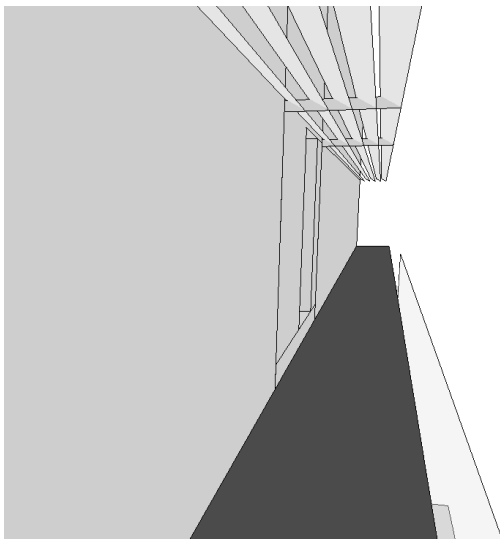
Detalle lamas inclinadas 30° en planta cuarta. Obtenida de Ecotec.
